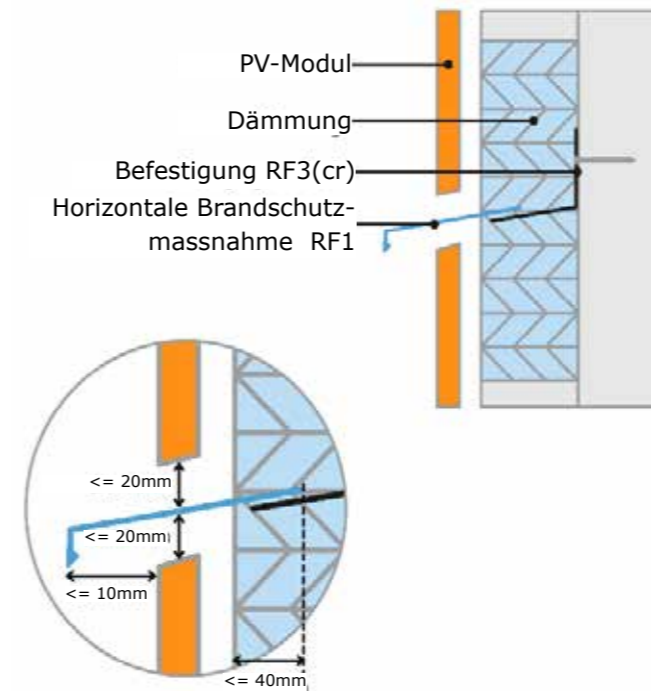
Schematische Darstellung einer horizontalen Brandabschottung durch ein mit Mineralwolle befülltes Chromnickelstahlelement (© GVB, verändert)
